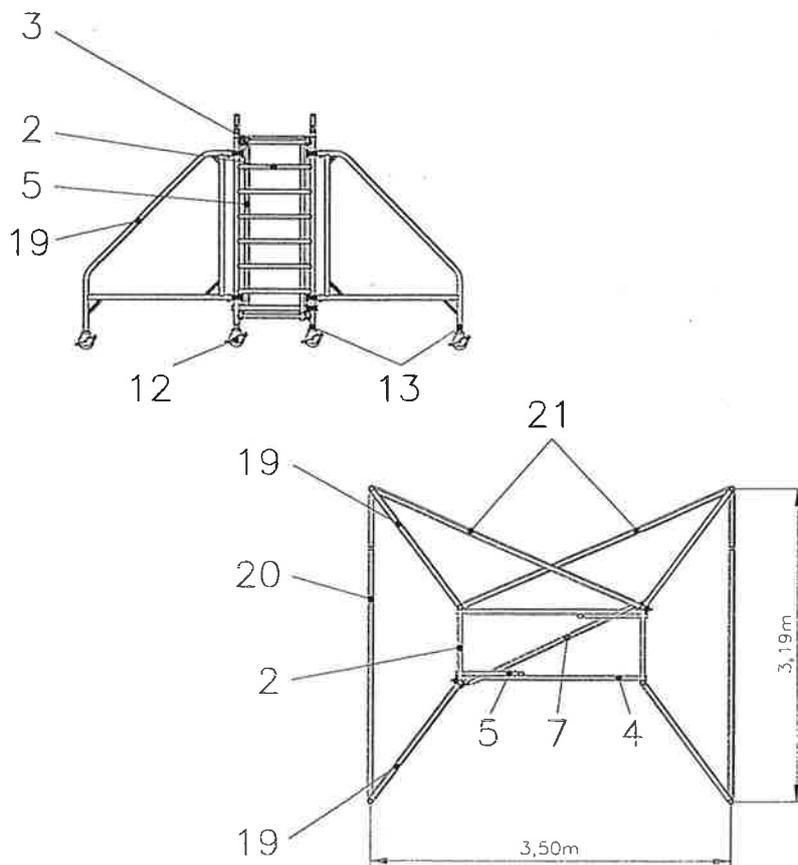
Aufbau der untersten Gerüstebene mit Auslegern
